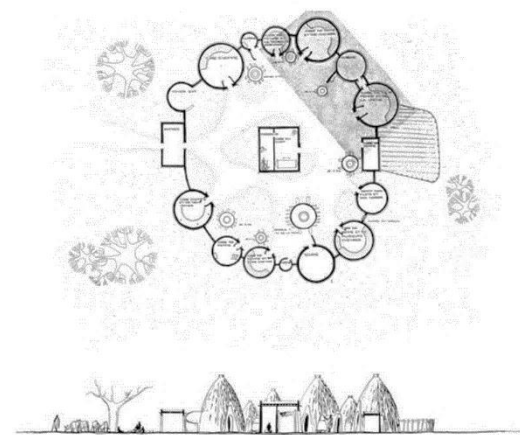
PLANTA Y ALZADO COMPLEJO MOUSGOUM
